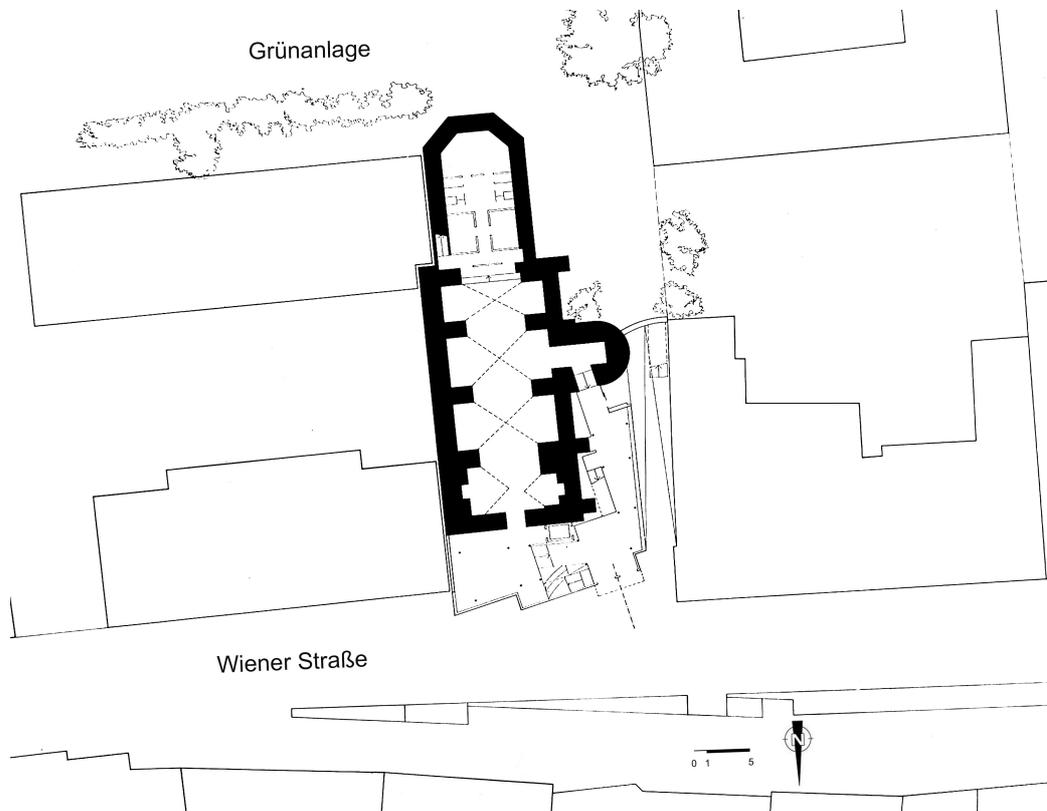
Lageplan des Kunsthhauses, Mürzzuschlag
